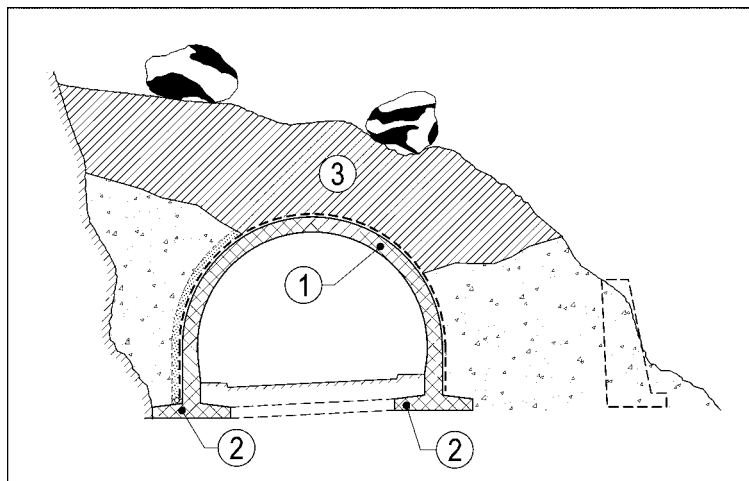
5 Galerie en voûte LEGENDE : ① Voûte pleine en béton armé avec étanchéité ép. 0.40 à 0.90 m. - ② Fondations, en général sur semelles filantes, év. liées par des sous-tirants - ③ Couche de couverture, ép. 1.50 à 3.0 m en matériaux calibrés
